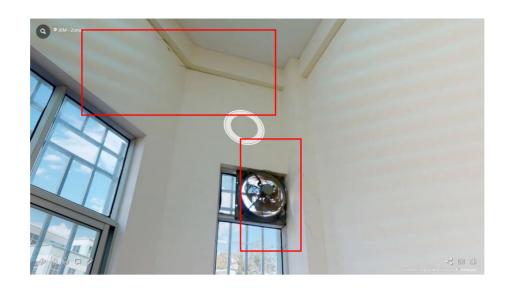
Lab. Química (Fisura de Columna)
